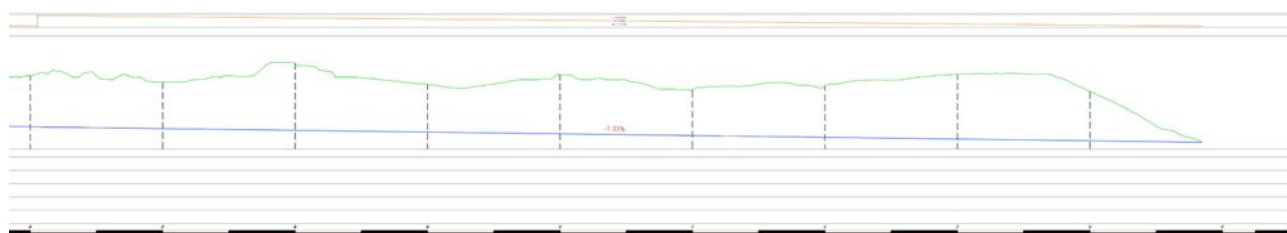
Parte 2 del profilo altimetrico d'asse dell'orizzontamento inferiore della galleria drenante.
